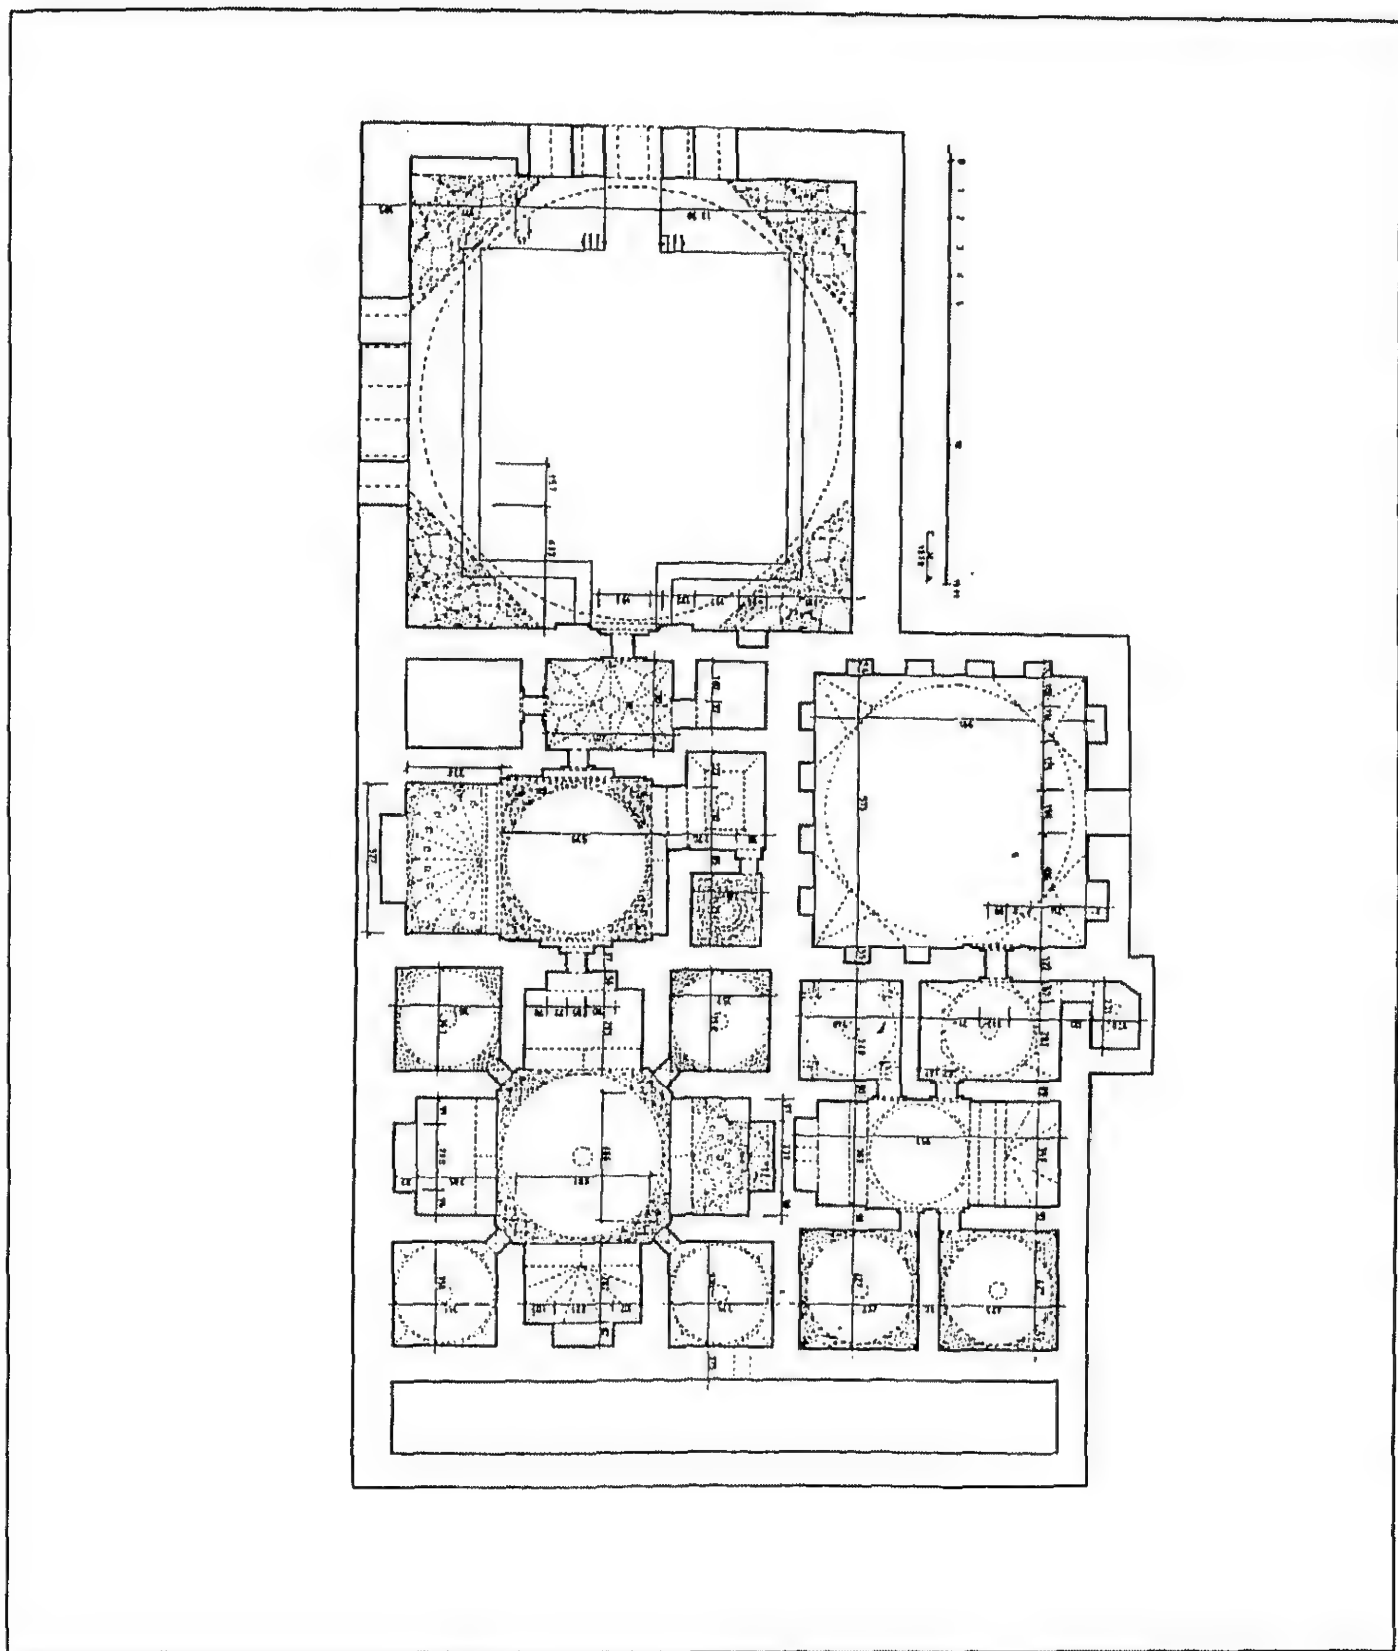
مسقط أفقي وقطاع لعمارت غازي أرنوس بك في كوموتيني باليونان
